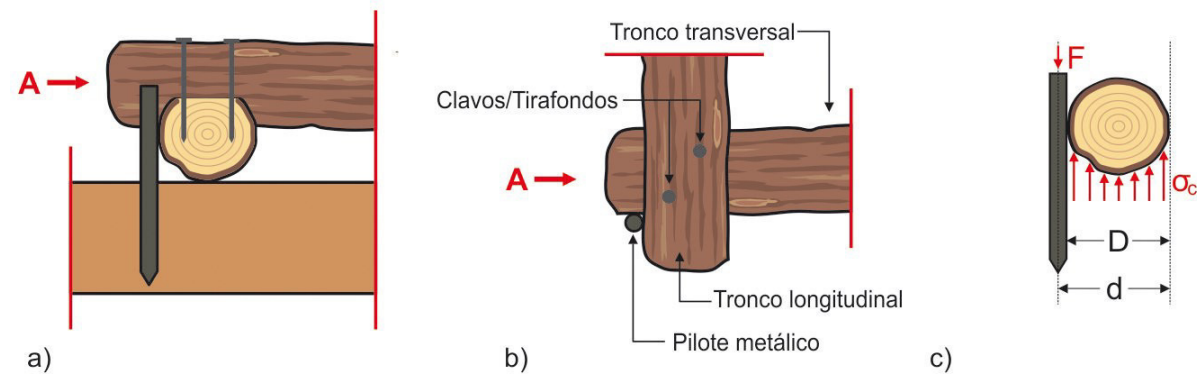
UNION DE ESTRUCTURAS DE PILOTES
